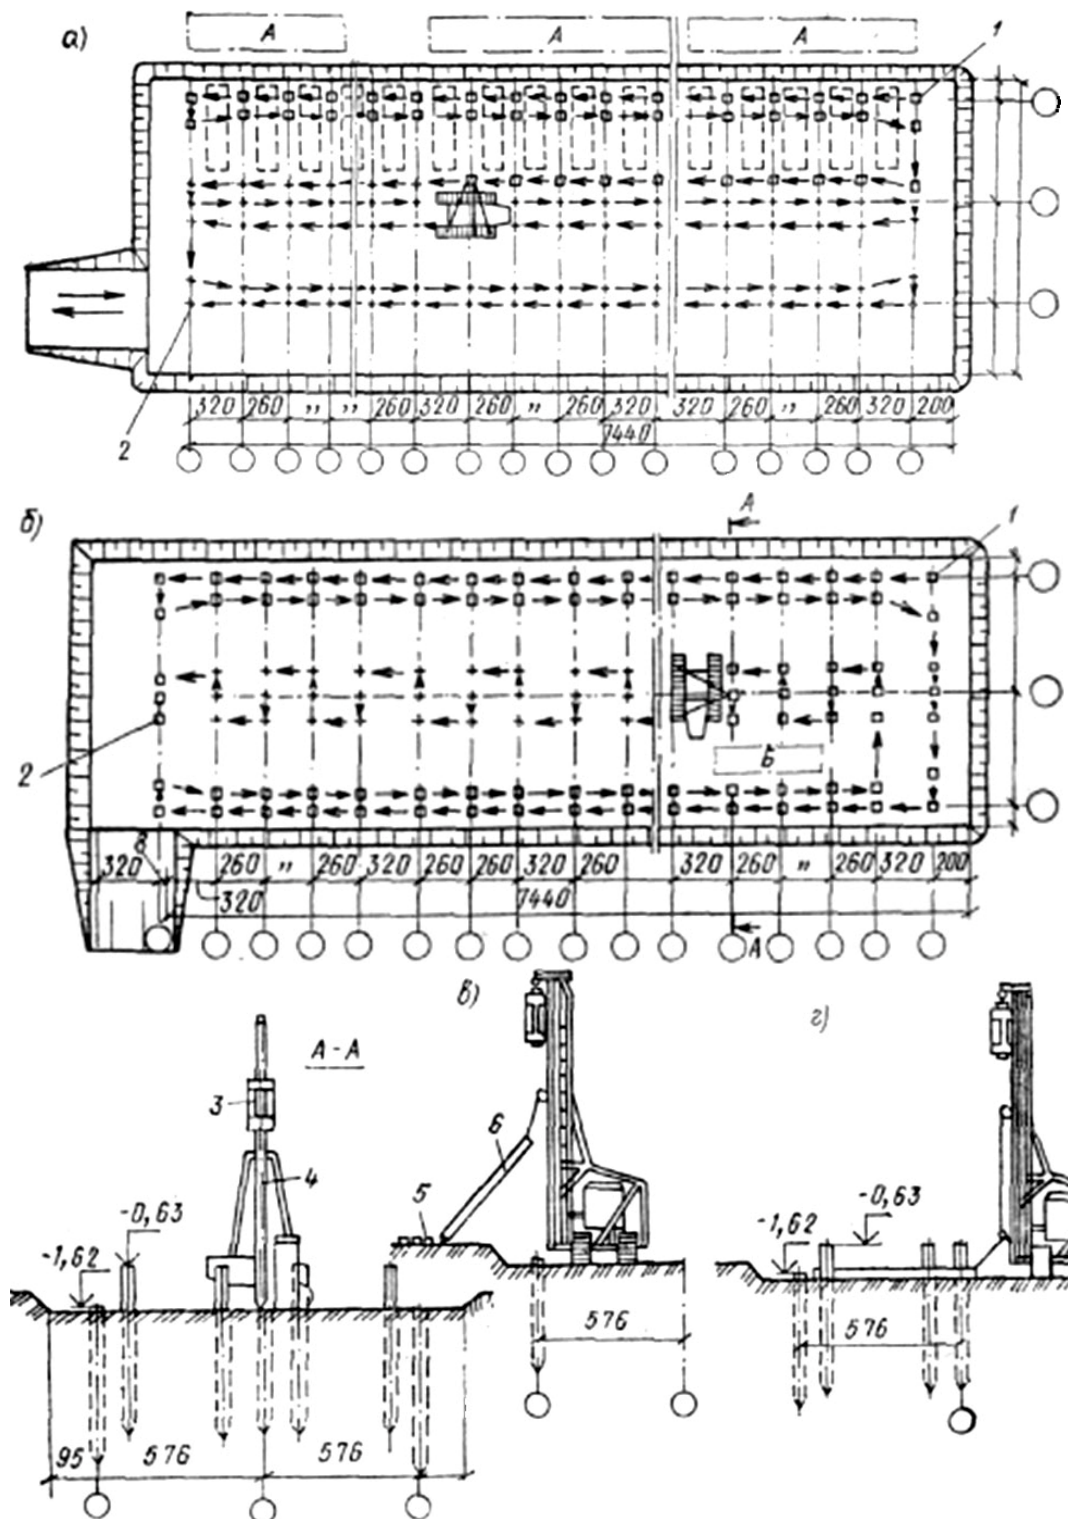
Последовательность забивки свай: *а, б* – варианты забивки свай копровой установкой С-714; *в* – схема подтаскивания свай на штабеля А; *г* – то же, из штабеля Б; 1 – начало работы; 2 – окончание работы; 3 – дизель-молот; 4 – забиваемые сваи; 5 – разложение свай; 6 – подтягивание свай копровой установкой
